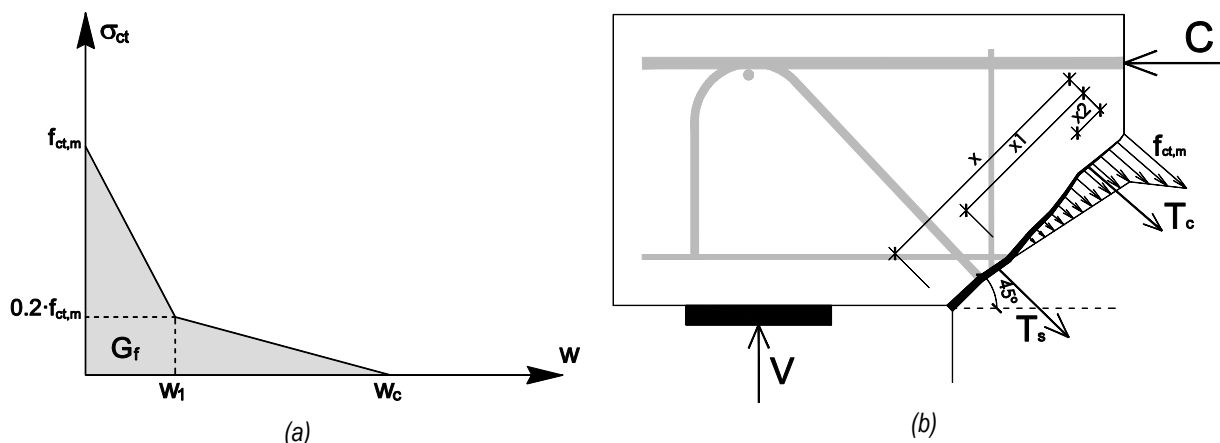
(a) Ley de softening en la fisura propuesta por MC-2010 [13]; (b) Esquema simplificado tracciones en el hormigón
